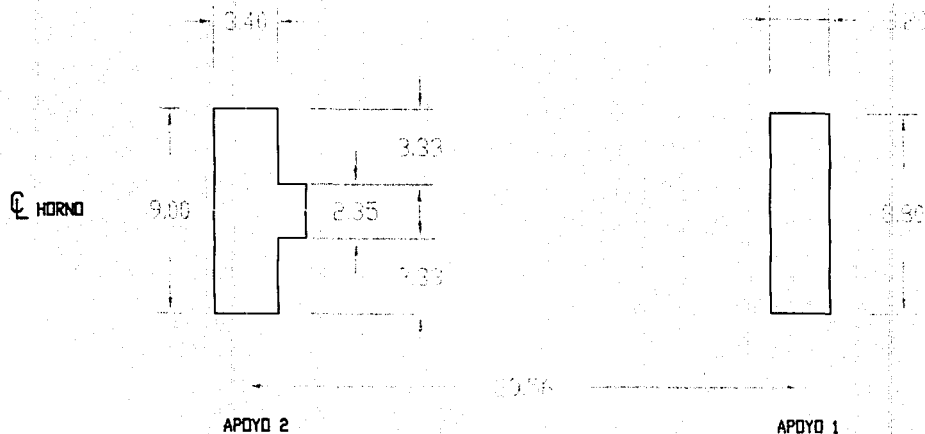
PLANTA Y CORTE DEL PRECALENTADOR
